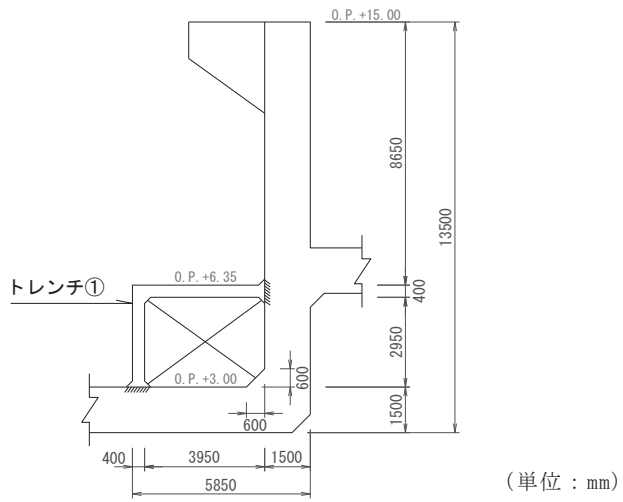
(7) 補機ポンプエリア断面図 (⑦—⑦断面)
